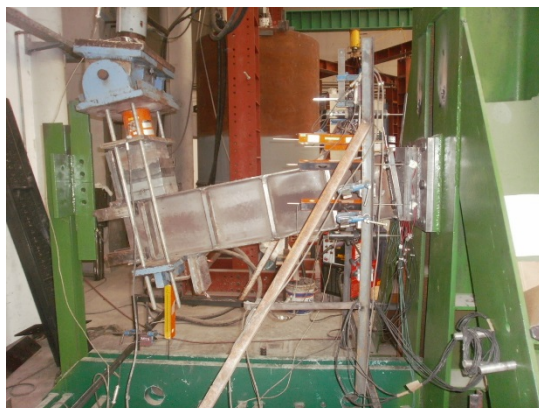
Perfil em U invertido de secção soldada.
